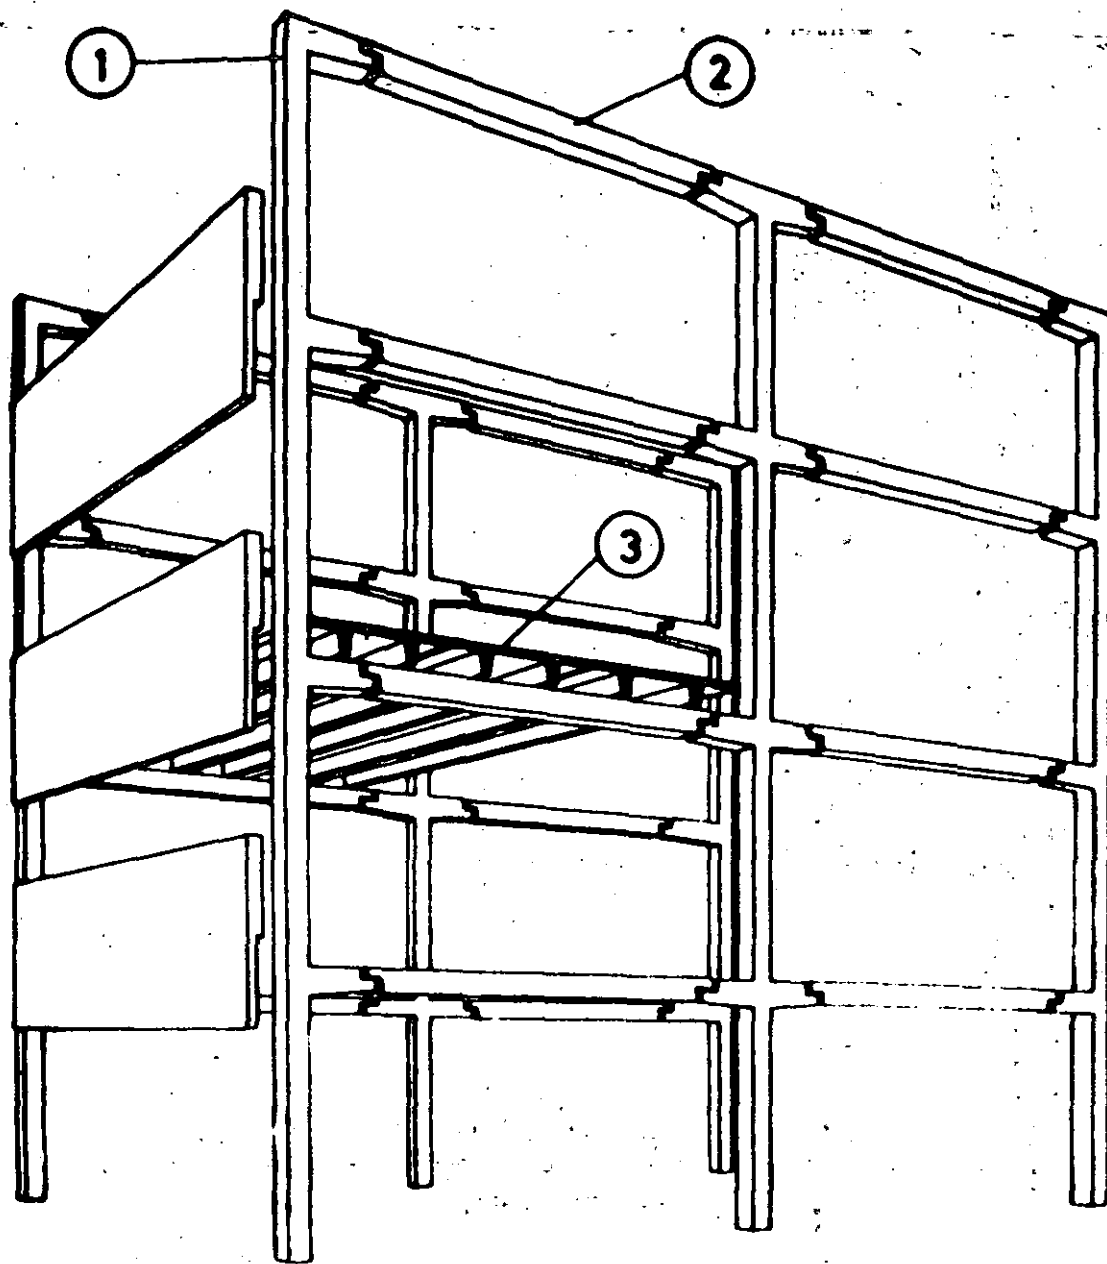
Pilares continuos, 1; en ménsulas para el apoyo de las vigas, 2; sobre las que descansa el forjado, 3. Fachadas como en la figura 2.
